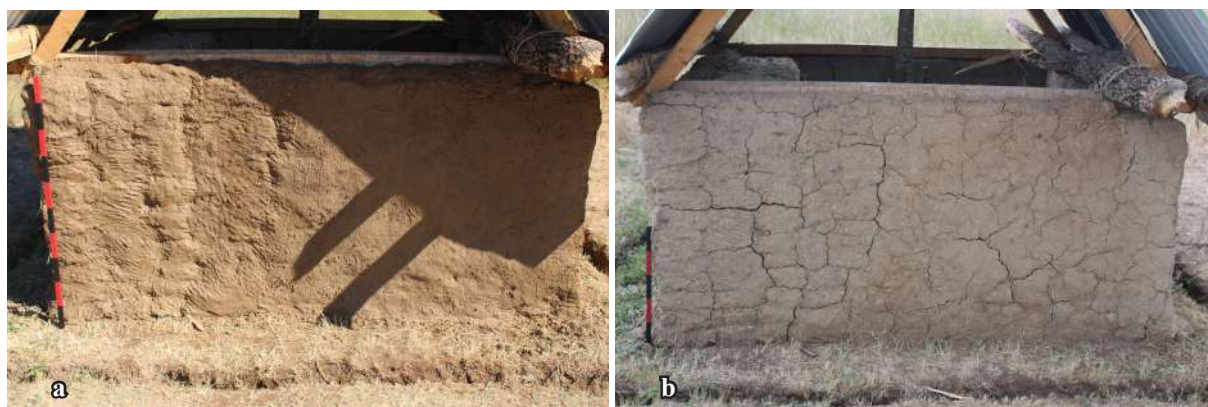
Mur nord, parement extérieur après la pose de l'enduit par « briquette ». a. dès la fin de l'application de l'enduit une différence est visible entre la partie ouest (droite) faite par un individu de niveau « 3-connaisseur » et la partie est (à gauche) faite par un individu de niveau « 1-débutant » ; b. les fissures suivent les limites des « briquettes » dans la partie faite par l'individu de niveau « 1-débutant », fragilisant sévèrement l'enduit.
